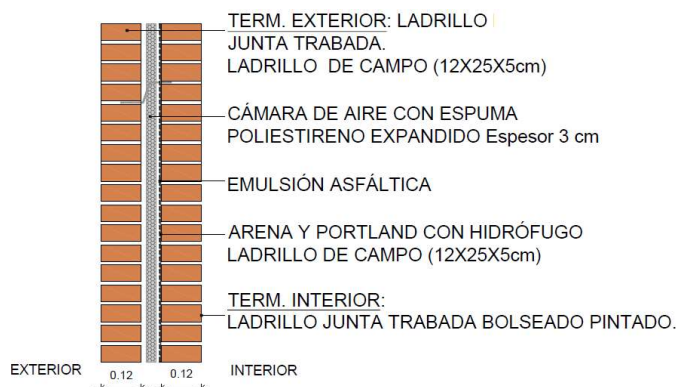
Corte esquemático de muros exteriores. Fuente: MEVIR (Expo Prado 2019)
